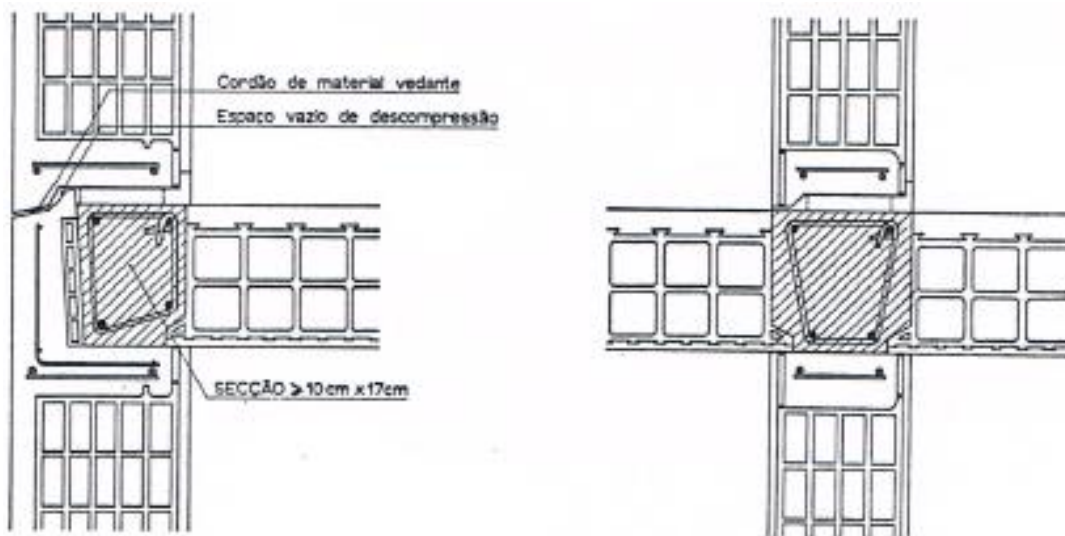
Pormenorização de cintas na direção da armadura da laje (LNEC, 1968).
